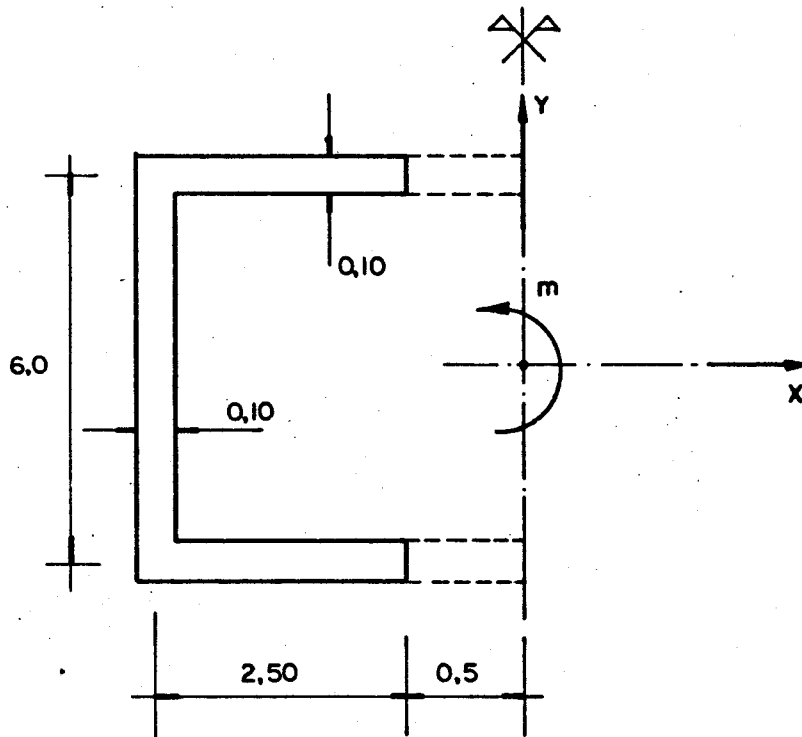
PLANTA DA ESTRUTURA EXEMPLO
